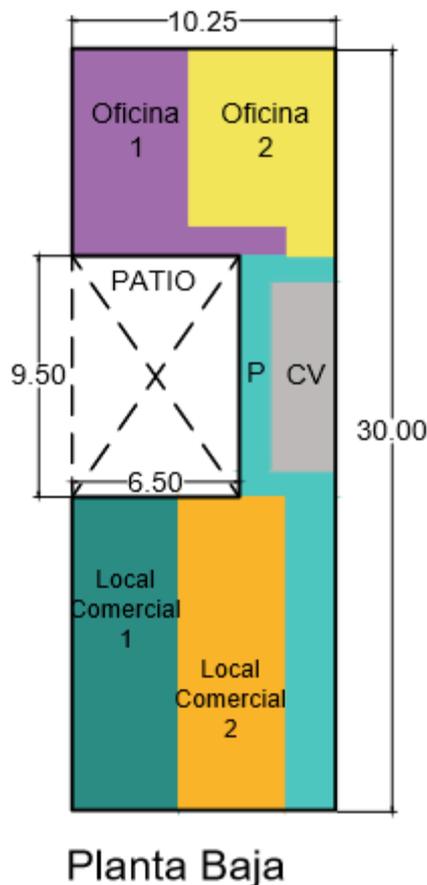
Unidades factibles de ser realizadas en planta baja.
